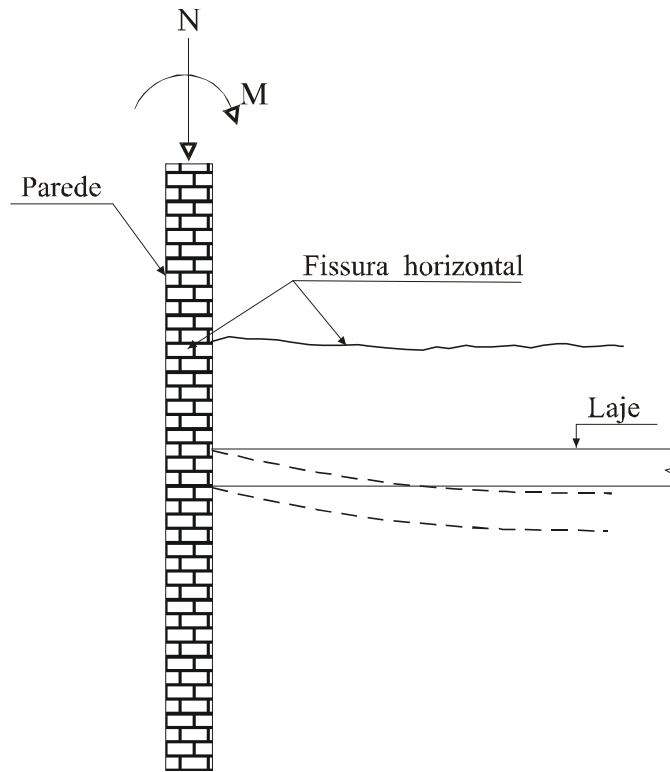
Fissura horizontal na parte inferior da alvenaria, causada pela deformação da laje que solicita a alvenaria à flexão composta
